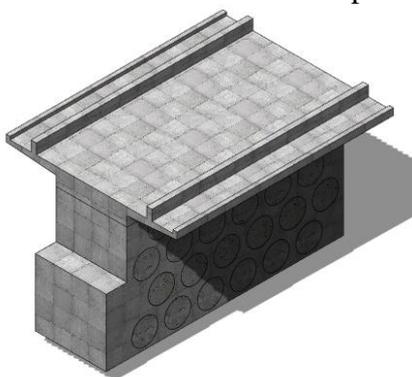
Preenchimento dos vazios com concreto magro e armaduras.
